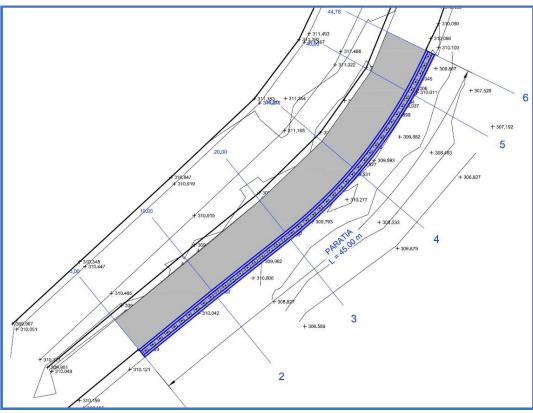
Zona intervento 1 – Planimetria dell'intervento
